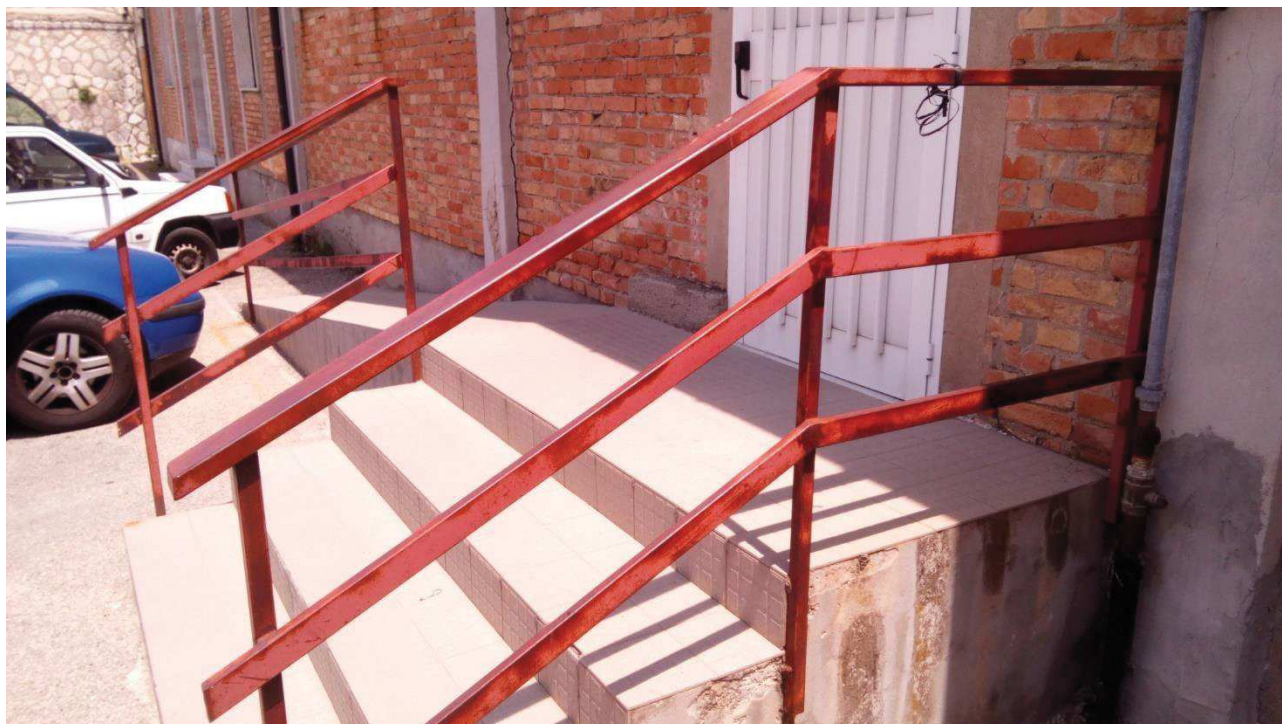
[Plesso San Pietro] Situazione ringhiere d'ingresso ante operam.
